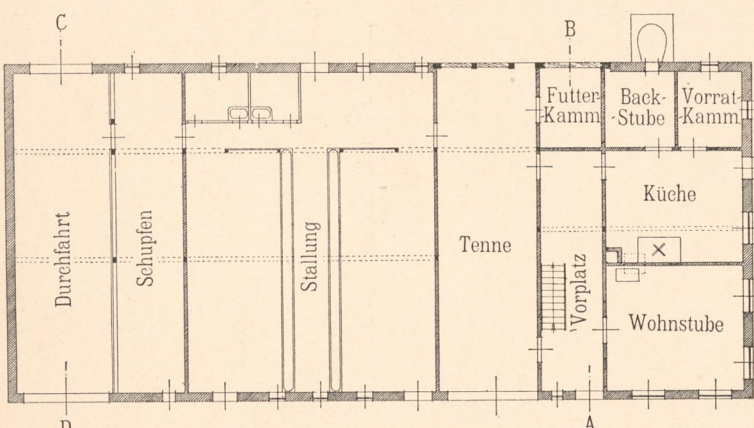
Bauernhaus Nr. 44 in Pless. Erdgeschoss.
